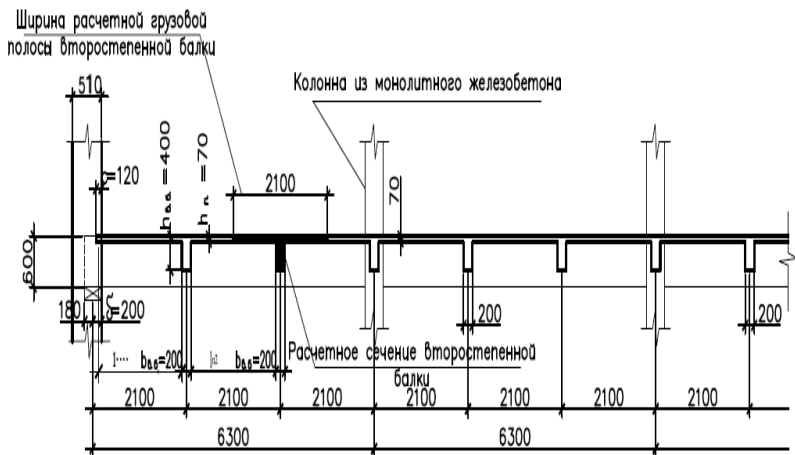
Конструктивная схема монолитной плиты и схема опирания опоры плиты на наружную стену
